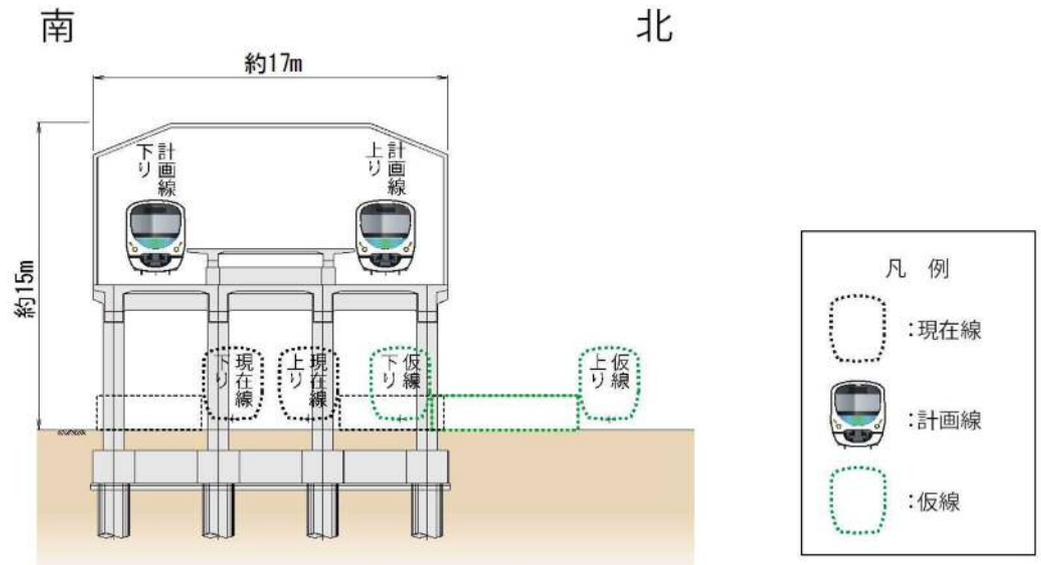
(1) 駅部標準断面図 (B-B' 断面：上井草駅)
